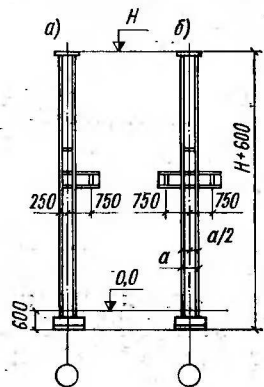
Колонны из двух двутавров для бескрановых зданий
